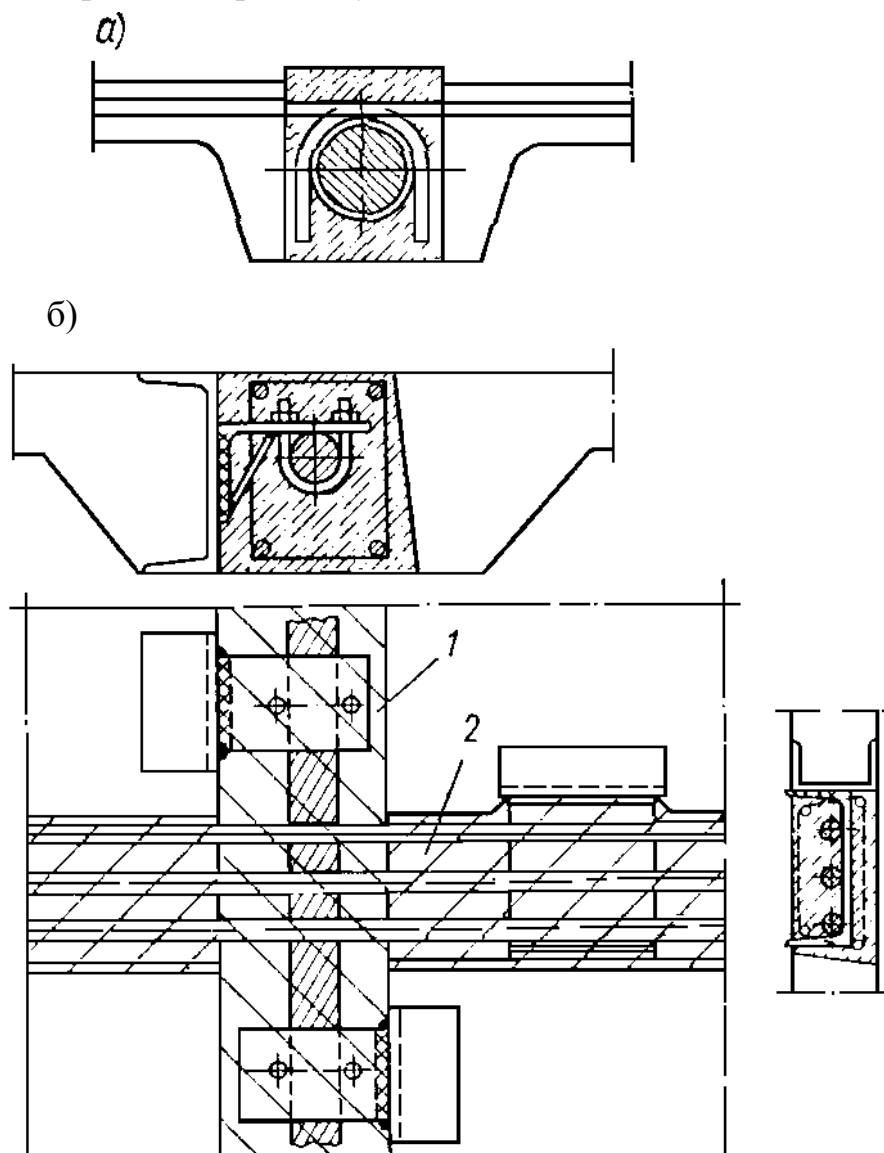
Сопряжение железобетонных плит с арматурой при напряжении пригрузом (а) и домкратами (б): 1, 2 – соответственно меридиональный и кольцевой швы.
